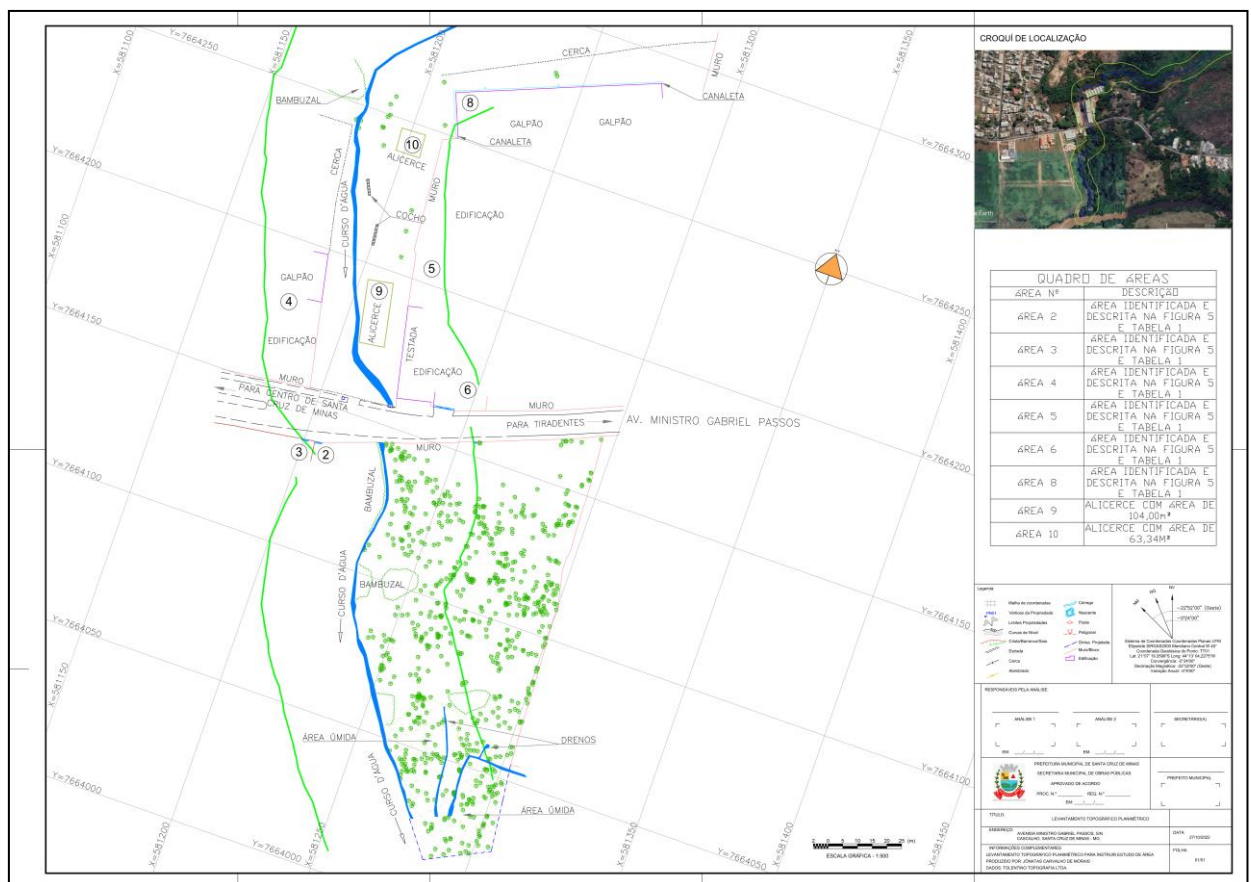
Planta Topográfica para instruir estudo de Área (Produzido pelo Autor)
